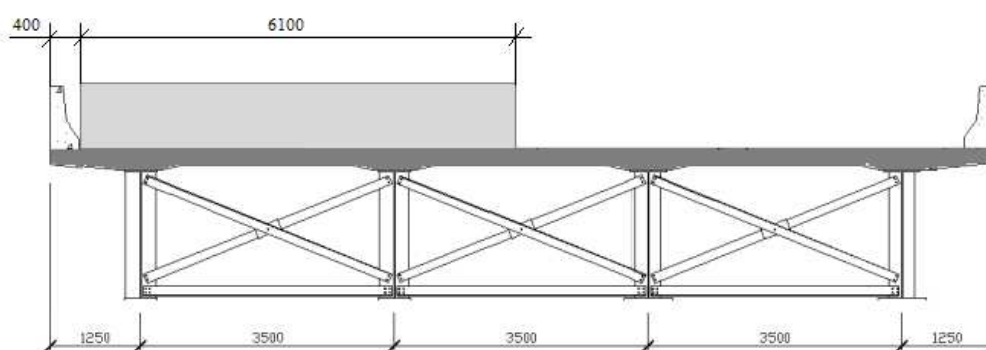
Posição da carga distribuída carregando 1/2 pistas. Dimensões em mm.
